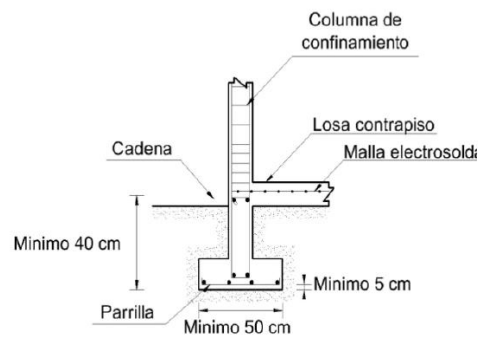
Dimensiones mínimas para vigas de cimentación en suelo resistente
